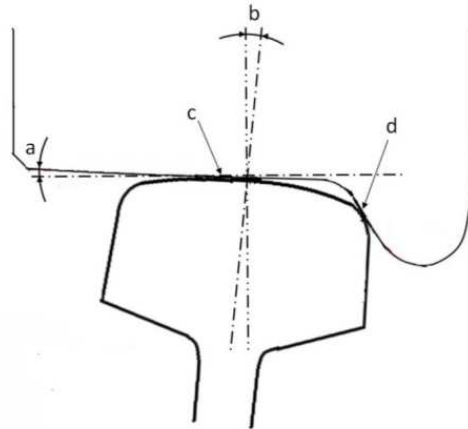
Esquema das posições de contacto roda-carril [18]: a) perfil cónico da roda; b) Tombo do carril; c) zona de contacto entre a roda e a cabeça do carril, d) Verdugo ou flange
